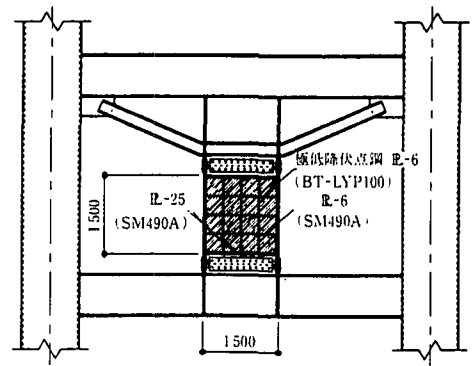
制震パネル詳細図(寸法単位:mm)
